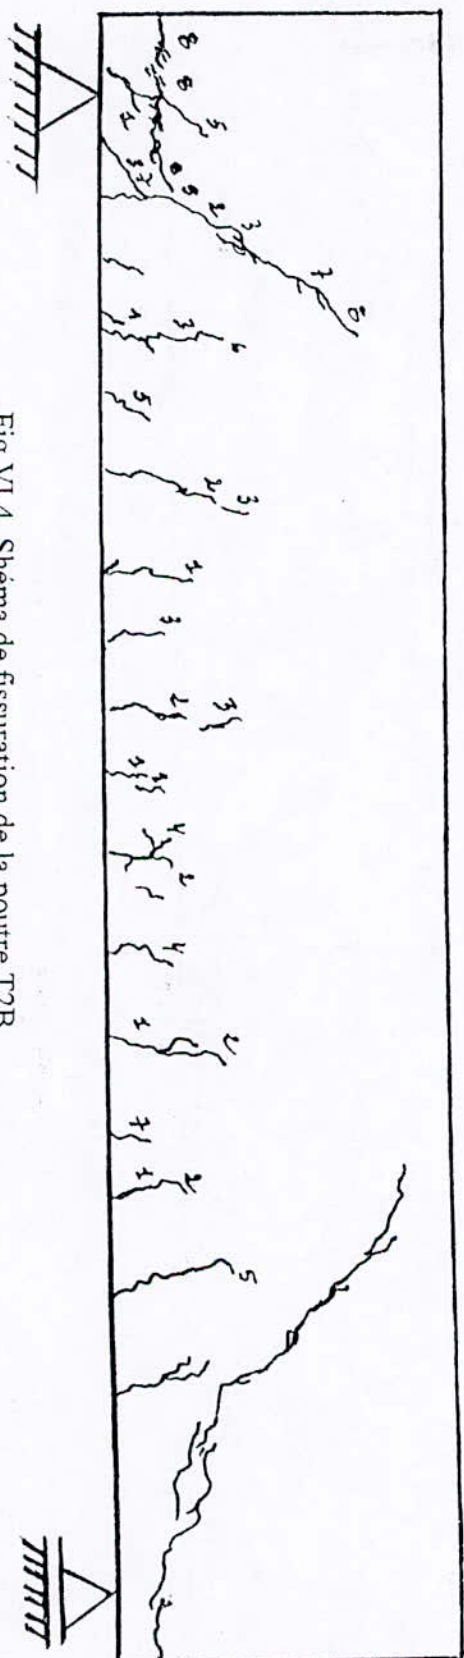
Schéma de fissuration de la poutre T2B
